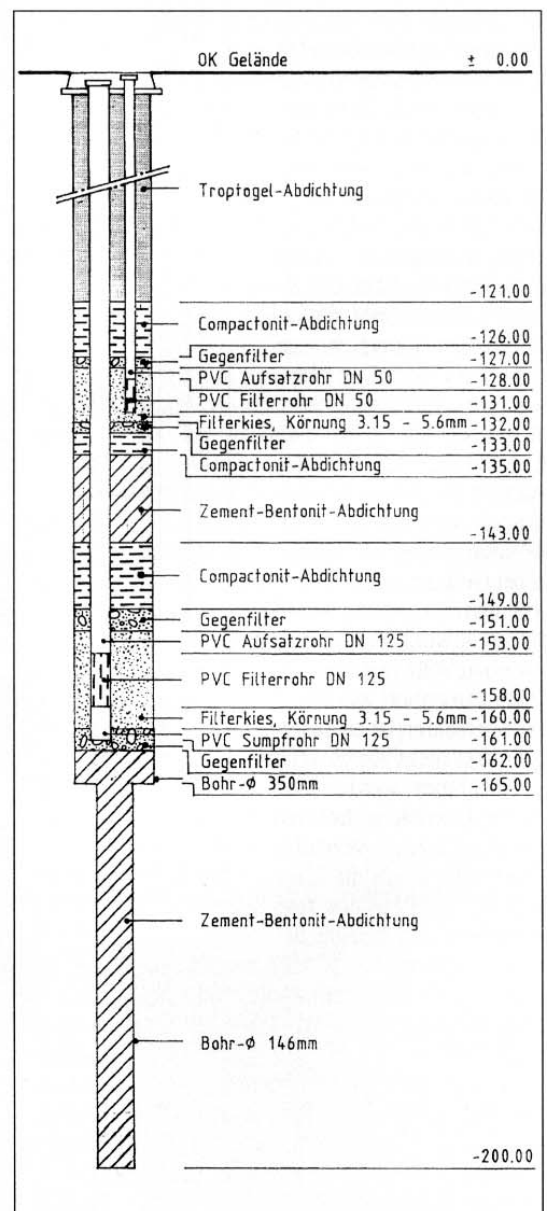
Ausbauplan Bohrung DB – NBS Stuttgart – Ulm
